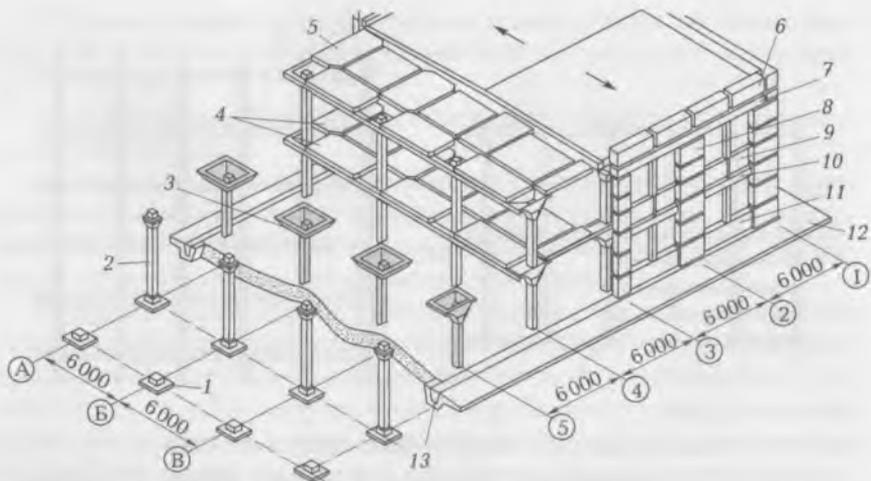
Многоэтажное здание с безбалочными конструкциями перекрытий:
